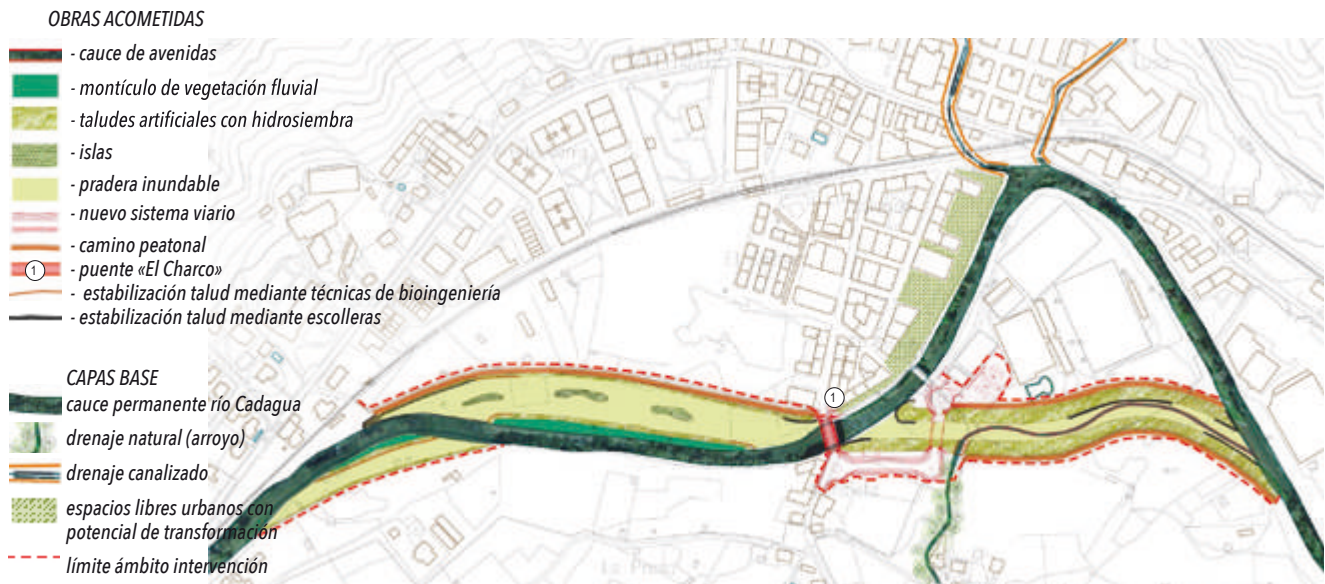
Planta de la intervención. Fuente: elaboración propia en base a la documentación del proyecto de URA, FULCRUM (2019)
